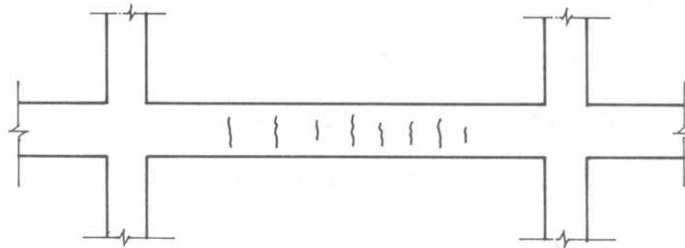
Fissuras de retração numa viga de concreto armado.
